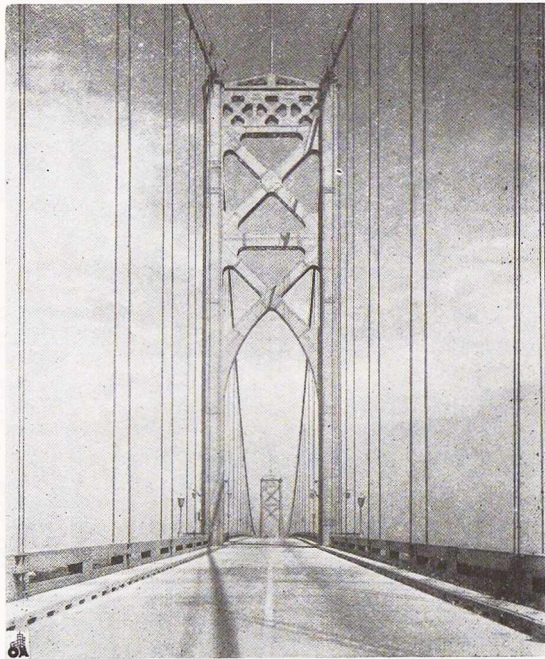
Pont Mount Hope franchissant la baie de Narragansett.
